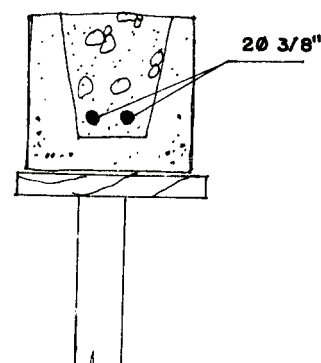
Vergas em alvenaria de bloco de concreto para vãos até 1,00m e entre 1,00m e 1,50m
